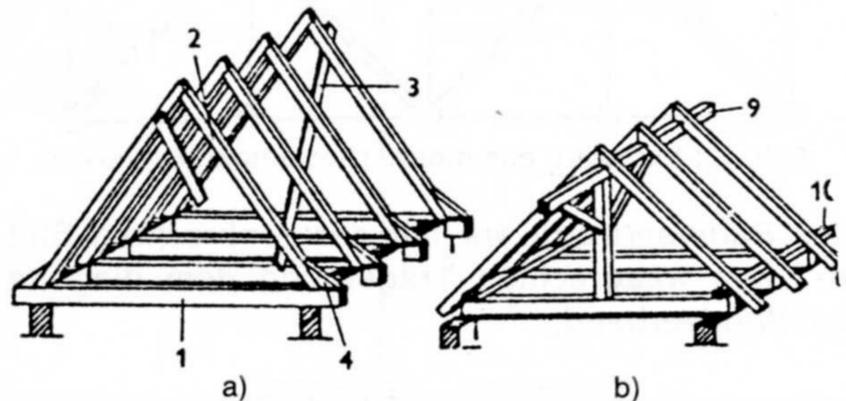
Dachkonstruktion: a) Sparrendach, b) einfaches Pfettendach.
